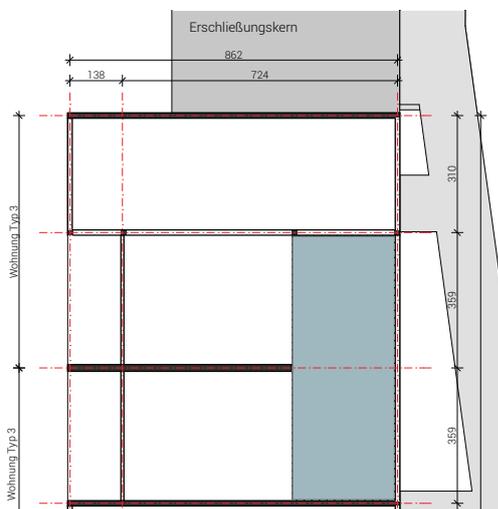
Grundriss Regelgeschoss BT B
